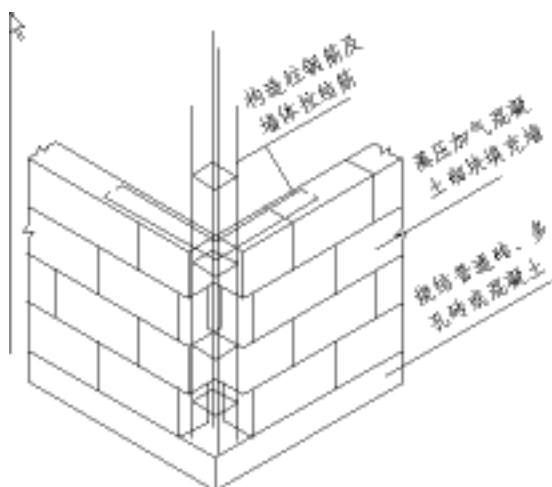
蒸压加气混凝土砌块填充墙构造柱
